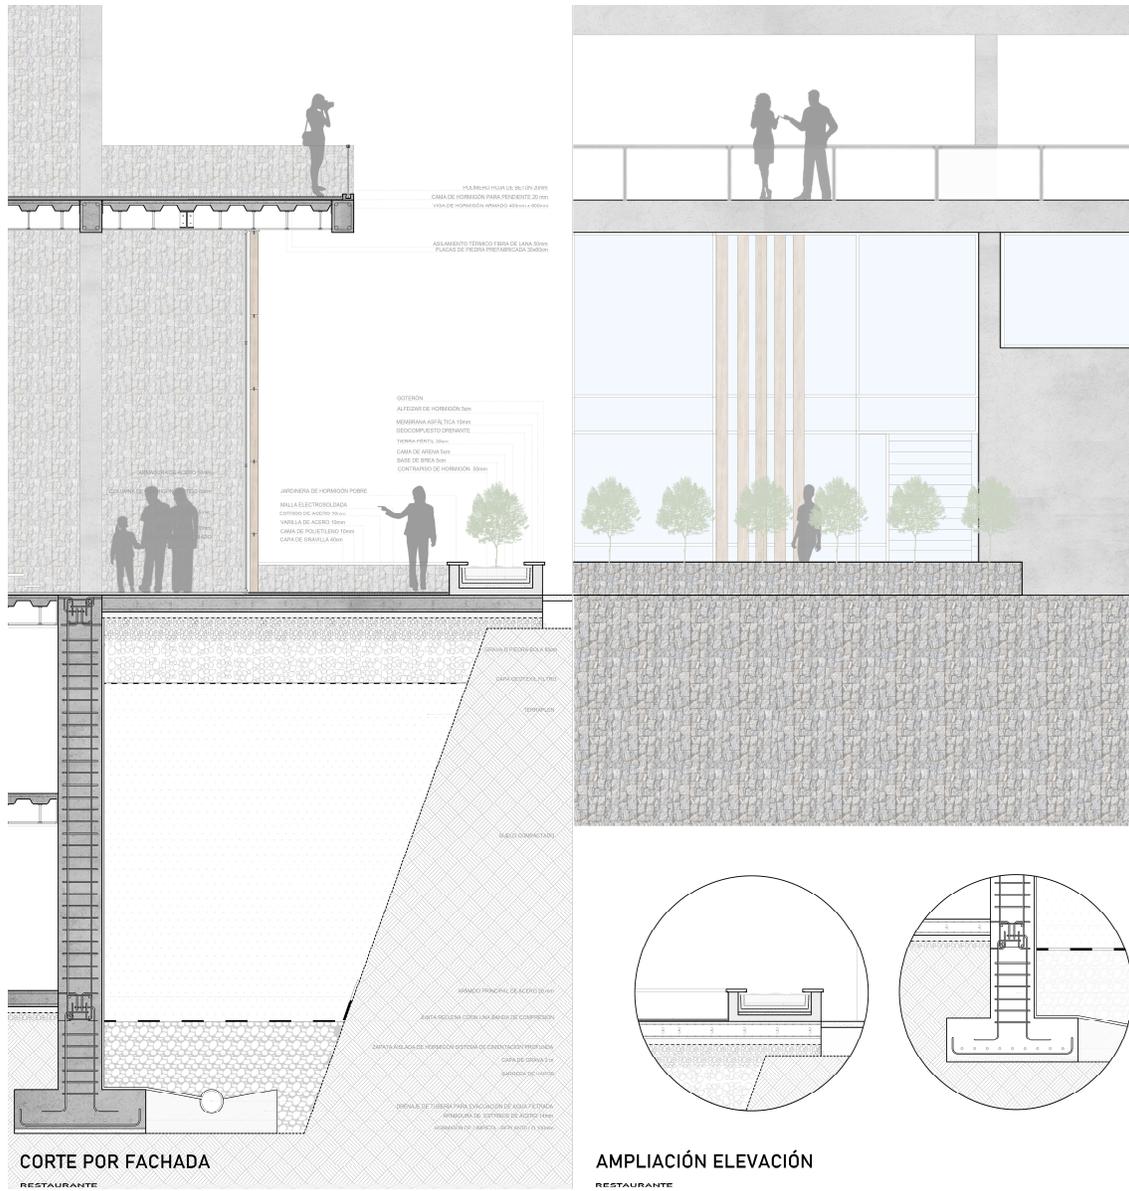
Corte por Fachada 2 / Resolución Constructiva. Elaboración propia
